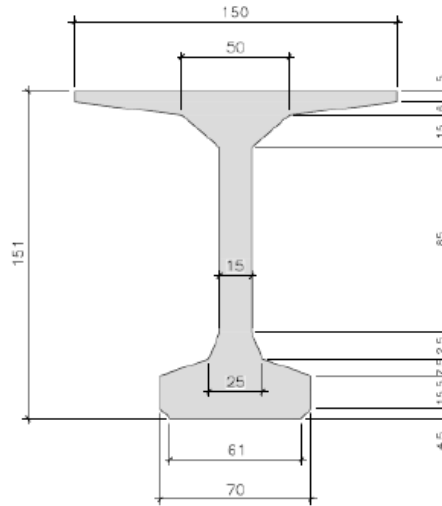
Sección transversal viga pretensada Puente Las Mercedes [9].
